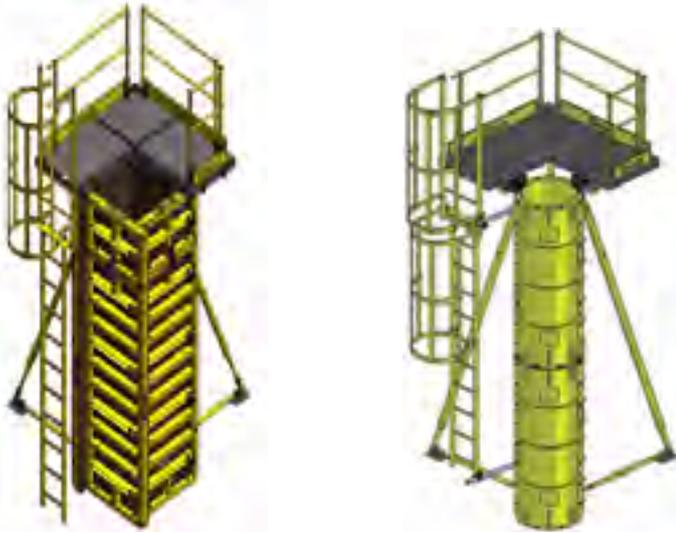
Ejemplo de sistemas de encofrado de pilas con acceso integrado.
